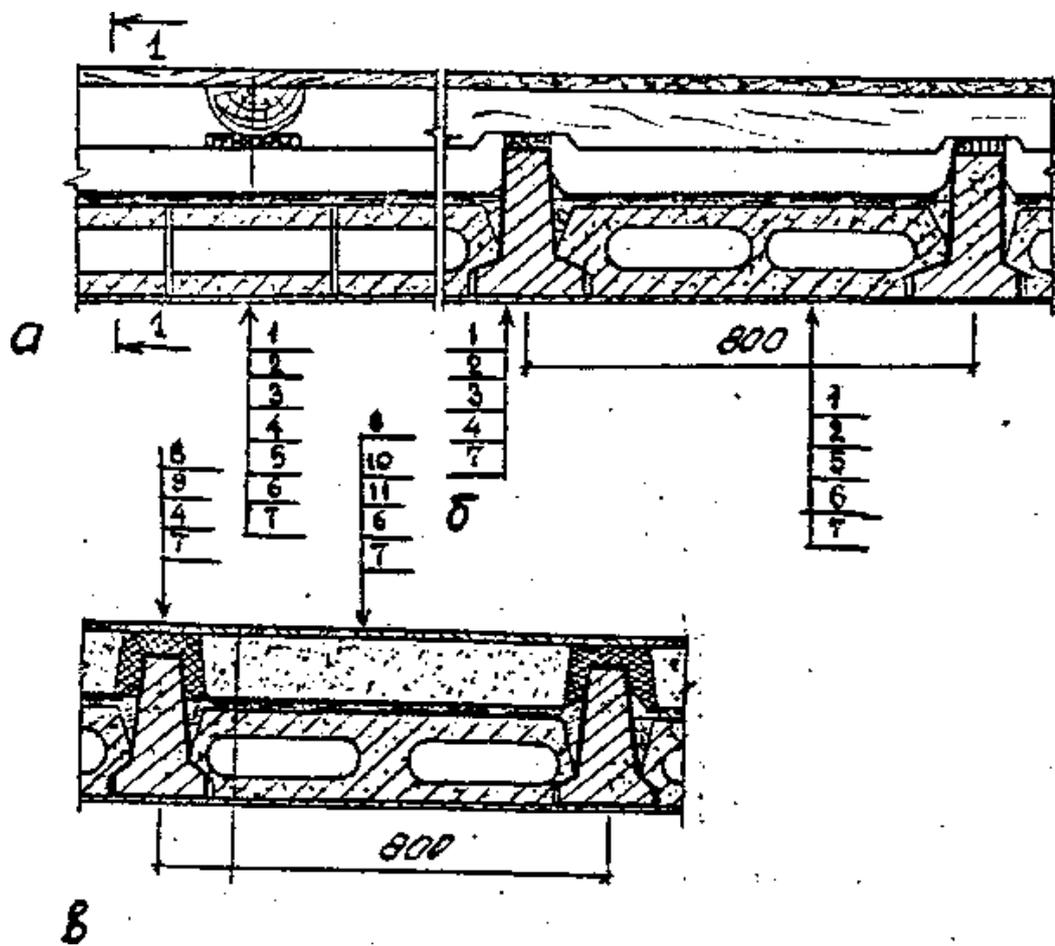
Приклад конструктивного вирішення перекриття по залізобетонних балках із заповненням пустотними вкладишами: а - міжповерхове перекриття; б - переріз 1-І; в - переріз горищного перекриття; 1 - дошки - 37; 2 - лага 140/2; 3 - пружна прокладка - 35; 4 - залізобетонна балка; 5 - промазка глиною; 6 - залізобетонний пустотний вкладиш - 140; 7 - тиньк -25; 8.- цементно-піщана стяжка - 25; 9 - утеплювач балки - мінеральна повсть; .10 - засипка керамзитовим гравієм - 100; 11 - пароізоляція – шар руберойду
